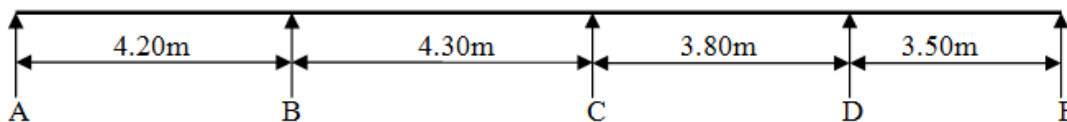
schéma statique de la poutre sur 5appuis
